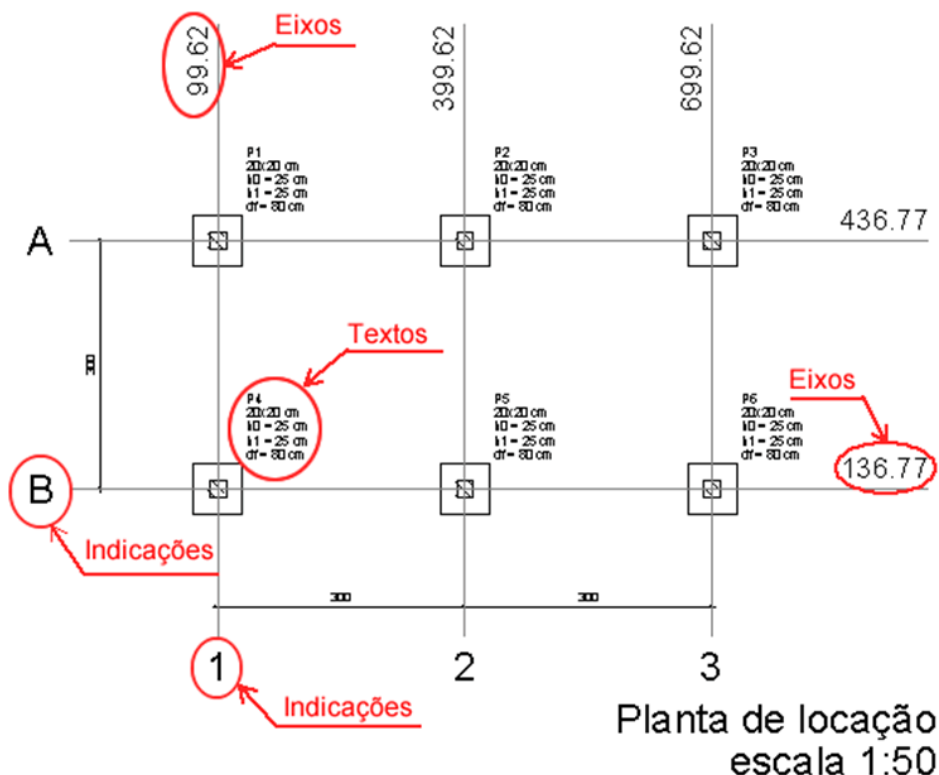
Exemplo de uma planta de locação meramente ilustrativo
